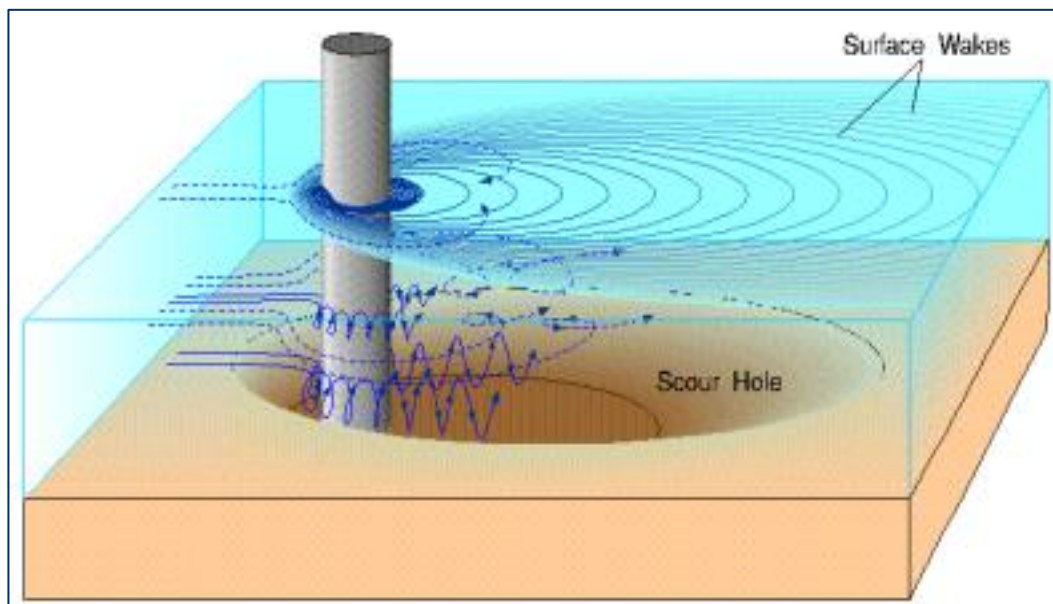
Phénomène d'affouillement au pied d'une pile de pont
